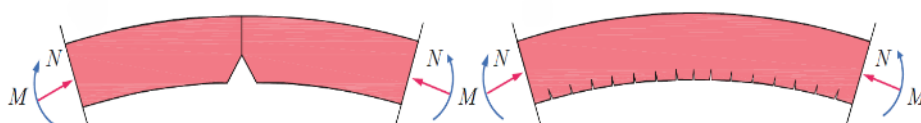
鋼筋混凝土與鋼纖維混凝土開裂方式之不同[13]
